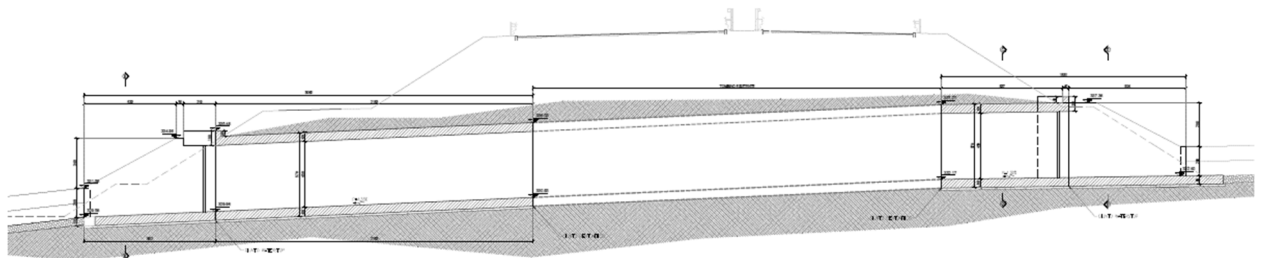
"Sezione longitudinale e rilevato stradale"
